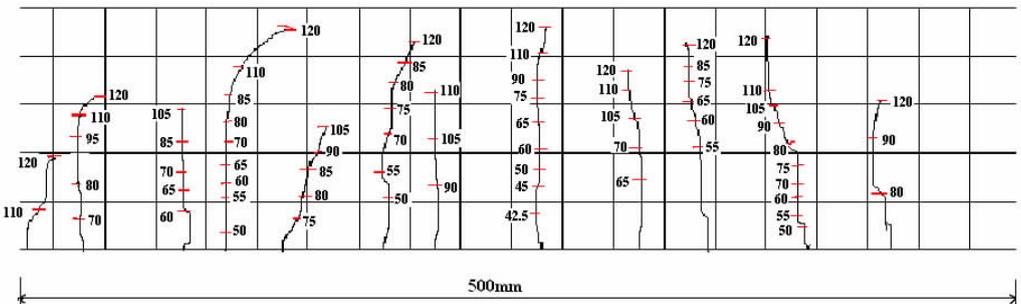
在分级载荷作用下钢纤维混凝土配筋梁的裂缝传播过程
